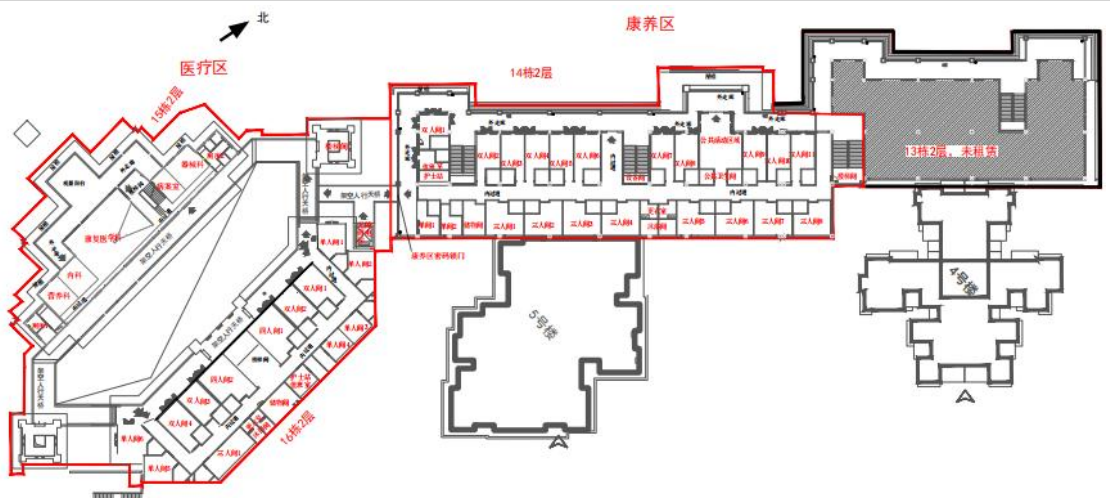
项目总平面布置图-2 层（环评推荐方案）
